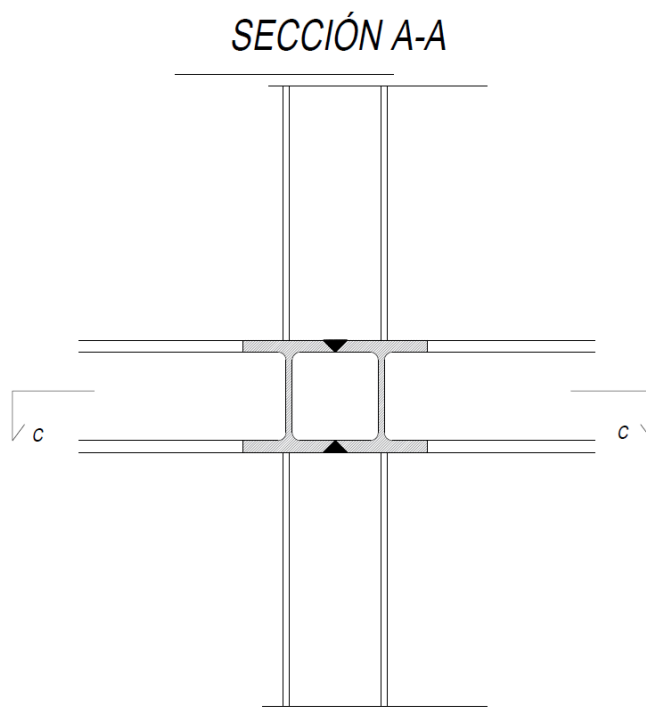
Sección de vigas HEM320 soldados en cajón, con pilar HEM400.
